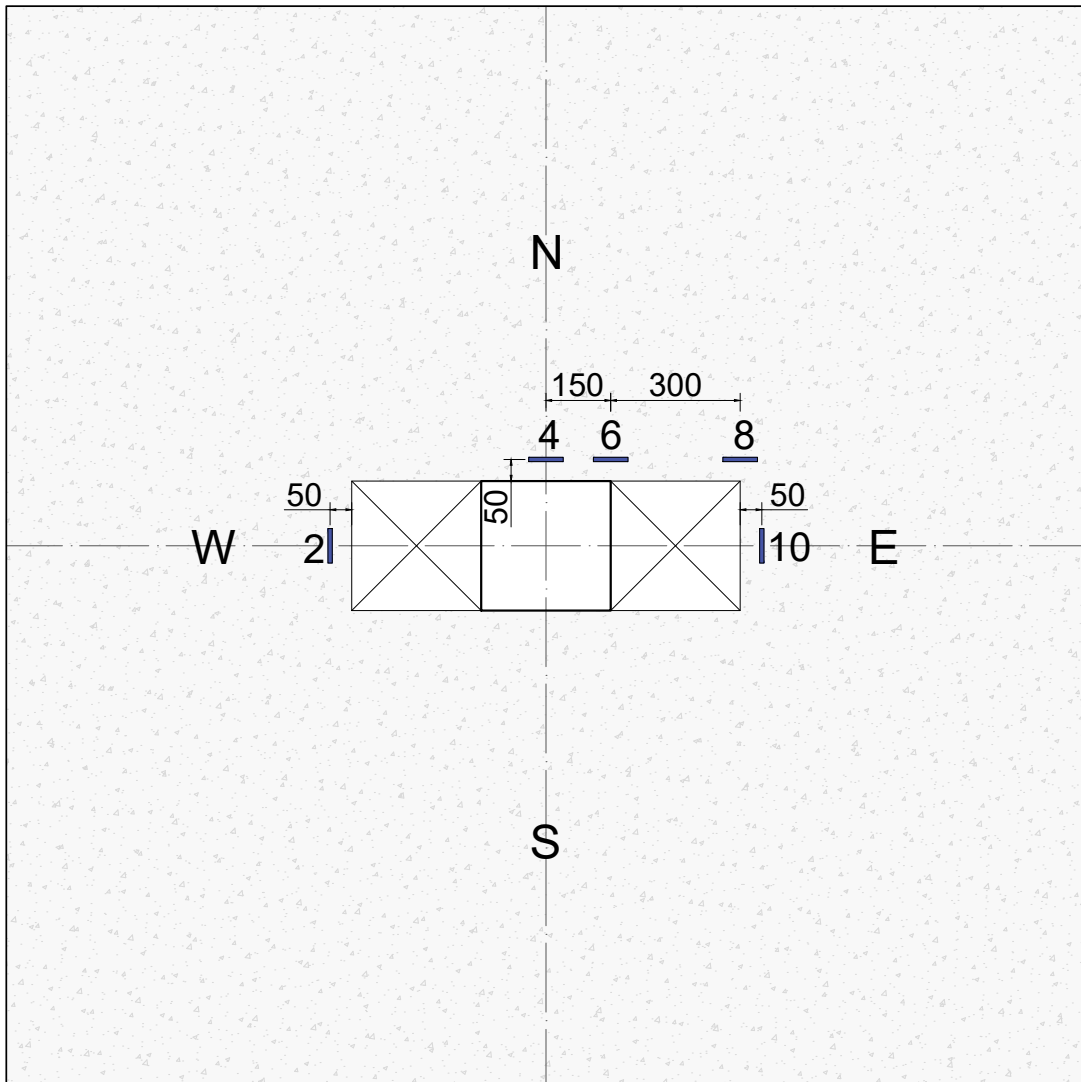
Posicionamento dos extensômetros tangenciais nas lajes com aberturas [mm]
